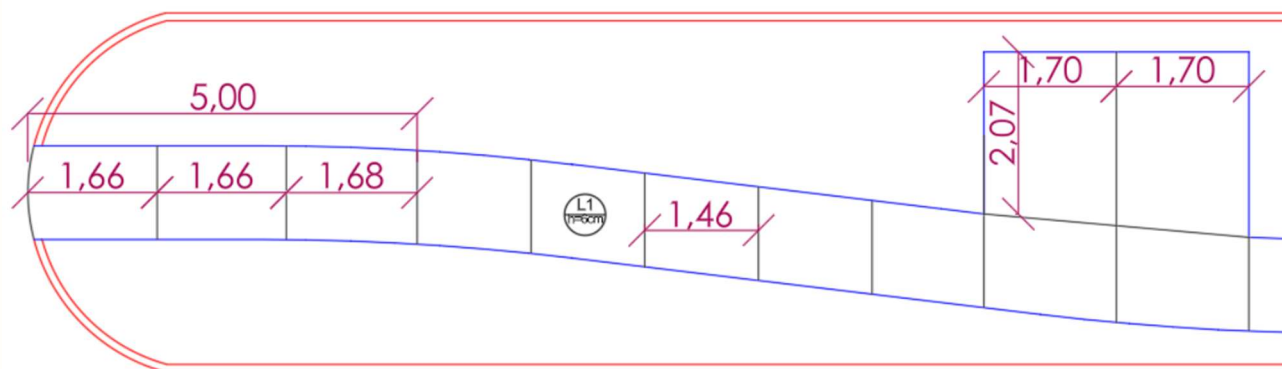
Demonstrativo demarcação panos de concretagem, conforme projeto.
